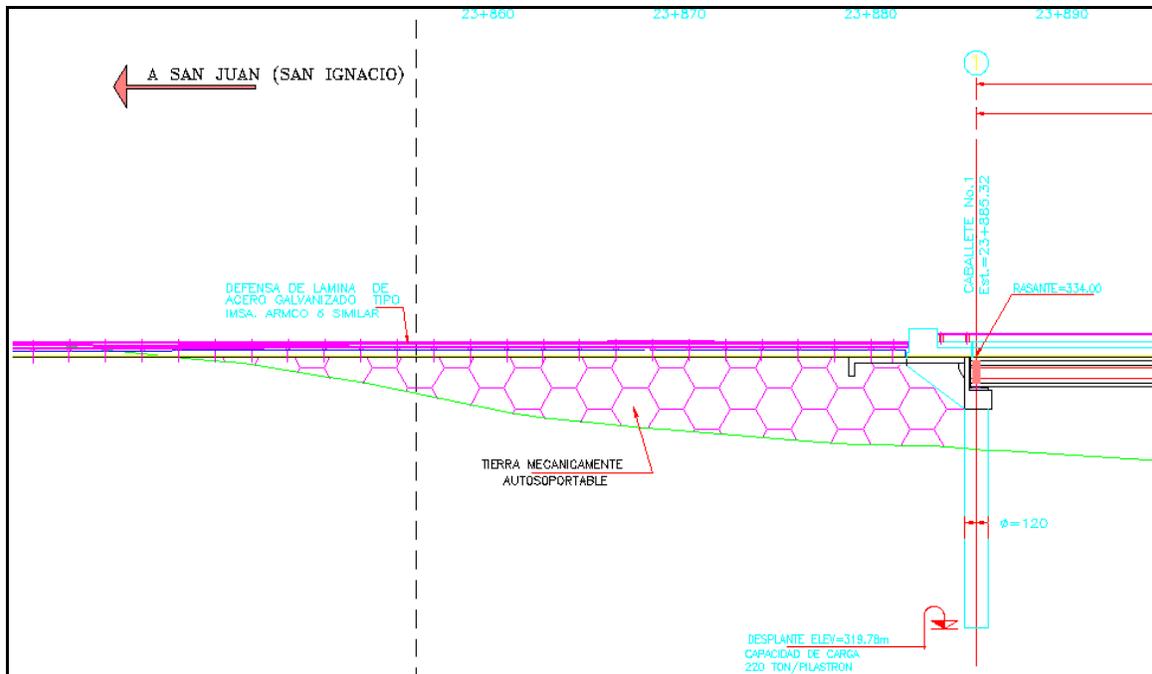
Detalle del acceso Sur, sobre la margen izquierda del arroyo Los Frailes.
